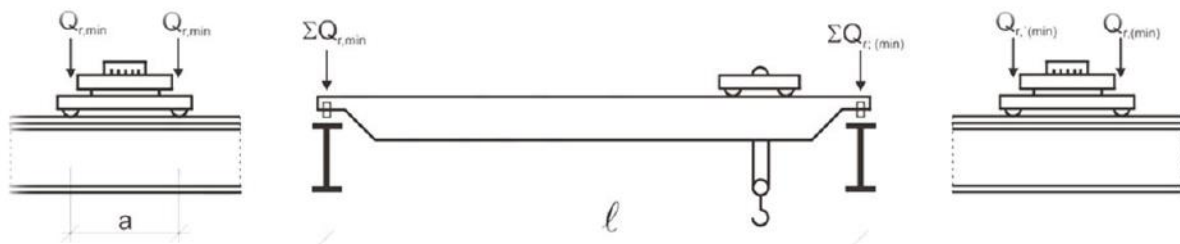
Disposition de charge de l'appareil de levage à vide pour obtenir un chargement minimal sur la poutre de roulement.
